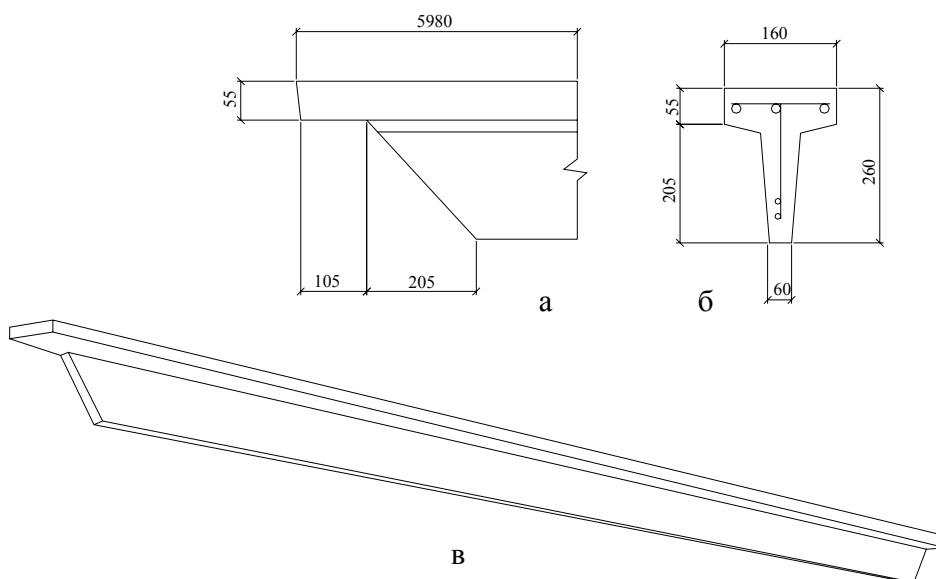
Залізобетонний тавровий прогін типу ПЖТ: а-опорна частина з підрізкою; б-поперечний переріз; в-загальний вид
